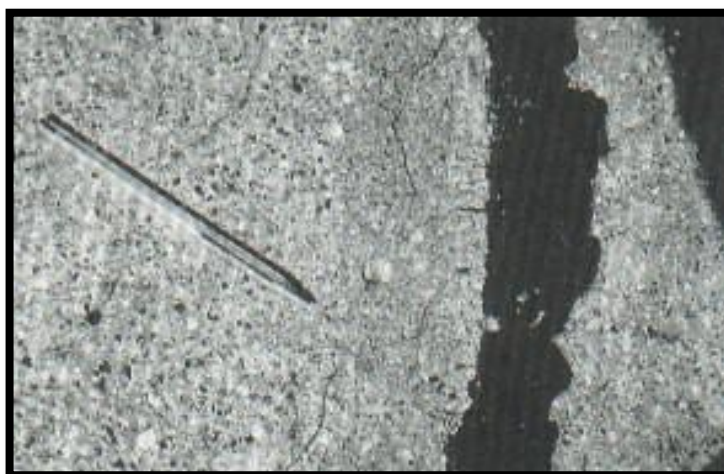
“Grieta de durabilidad “D” de baja severidad”⁽²⁰⁾.
